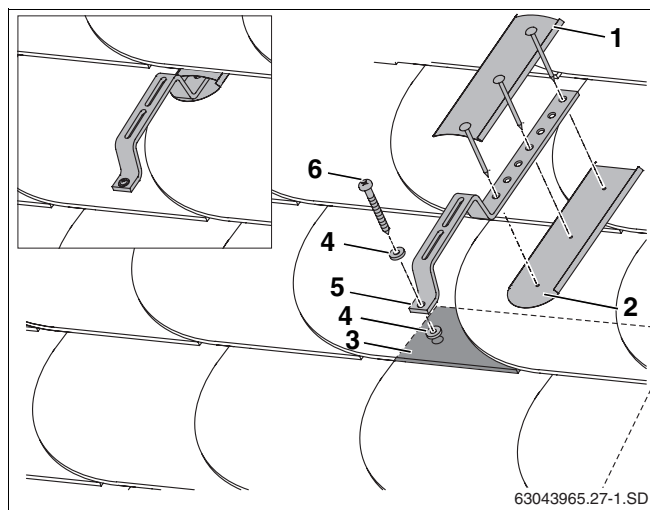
Instalação sobre telhado de ardósia ou de ripas
